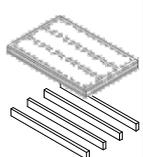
DETAILPUNKT AW-GD  =EINBINDUNG DER GESCHOSSDECKE IN DIE AUSSENWAND
